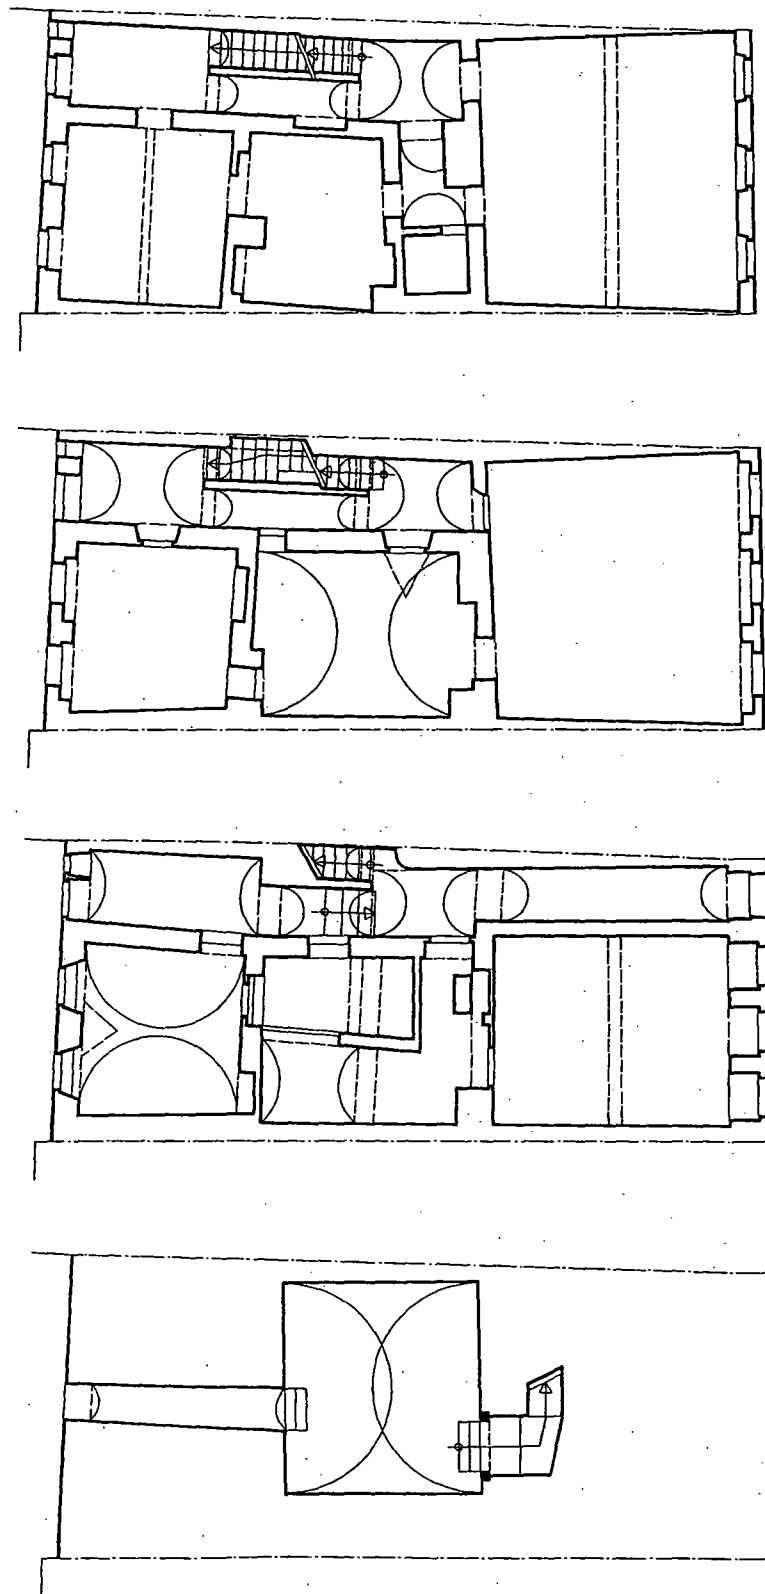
Stadtplatz 11 – Grundrisse Keller, Erdgeschoss, 1. und 2. Obergeschoss (1:200).
